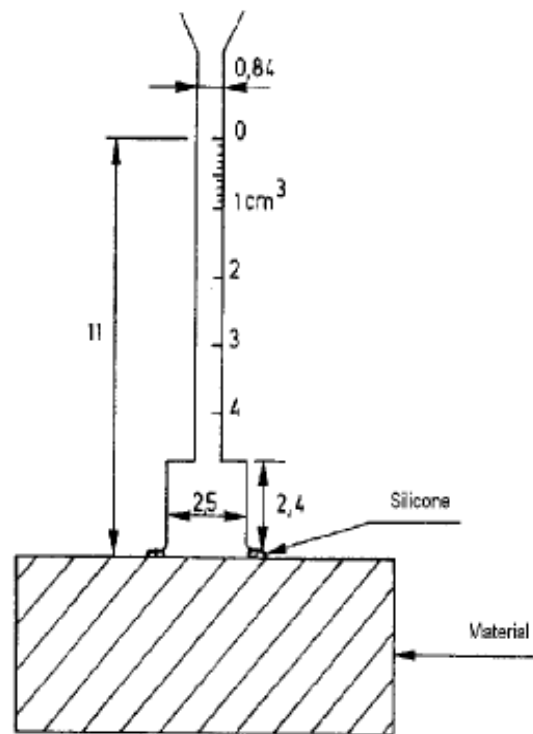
Esquema do Tubo de Carsten para superfícies horizontais
